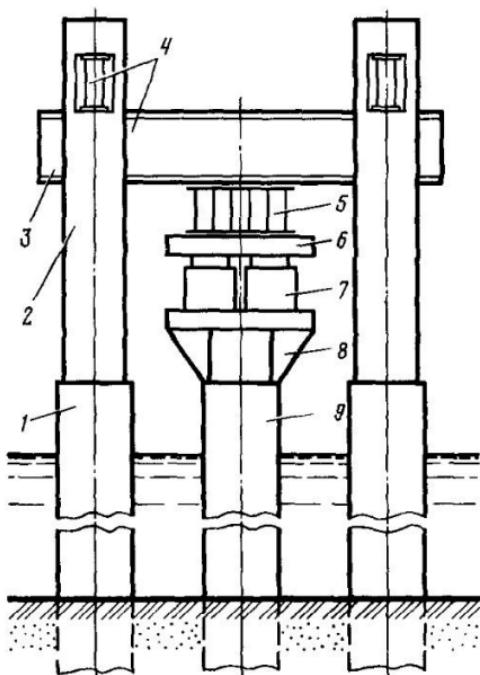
Установка для испытания вдавливающей нагрузкой свайного элемента:
